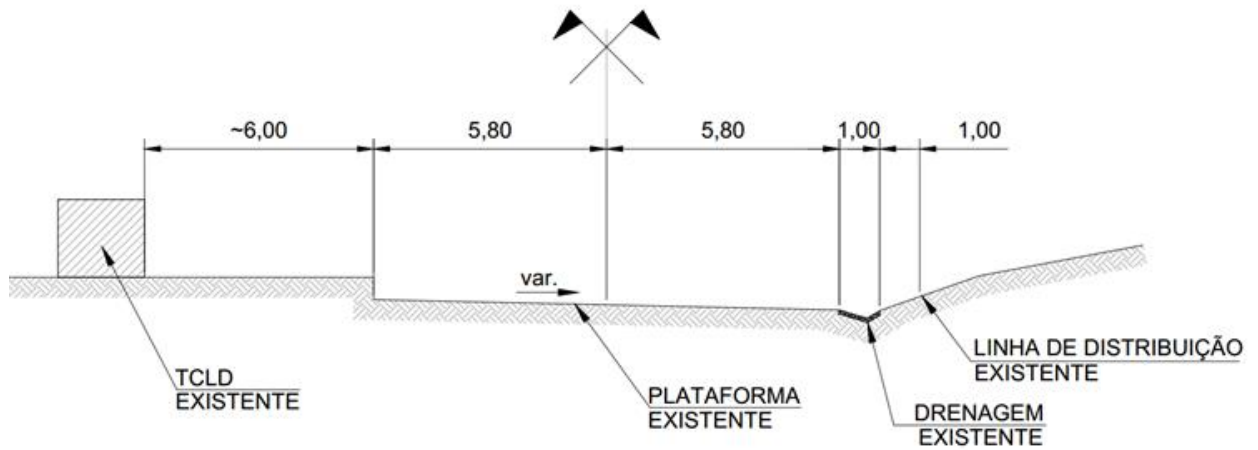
Vista da Seção Transversal Estrada Existente (dimensões aproximadas)
